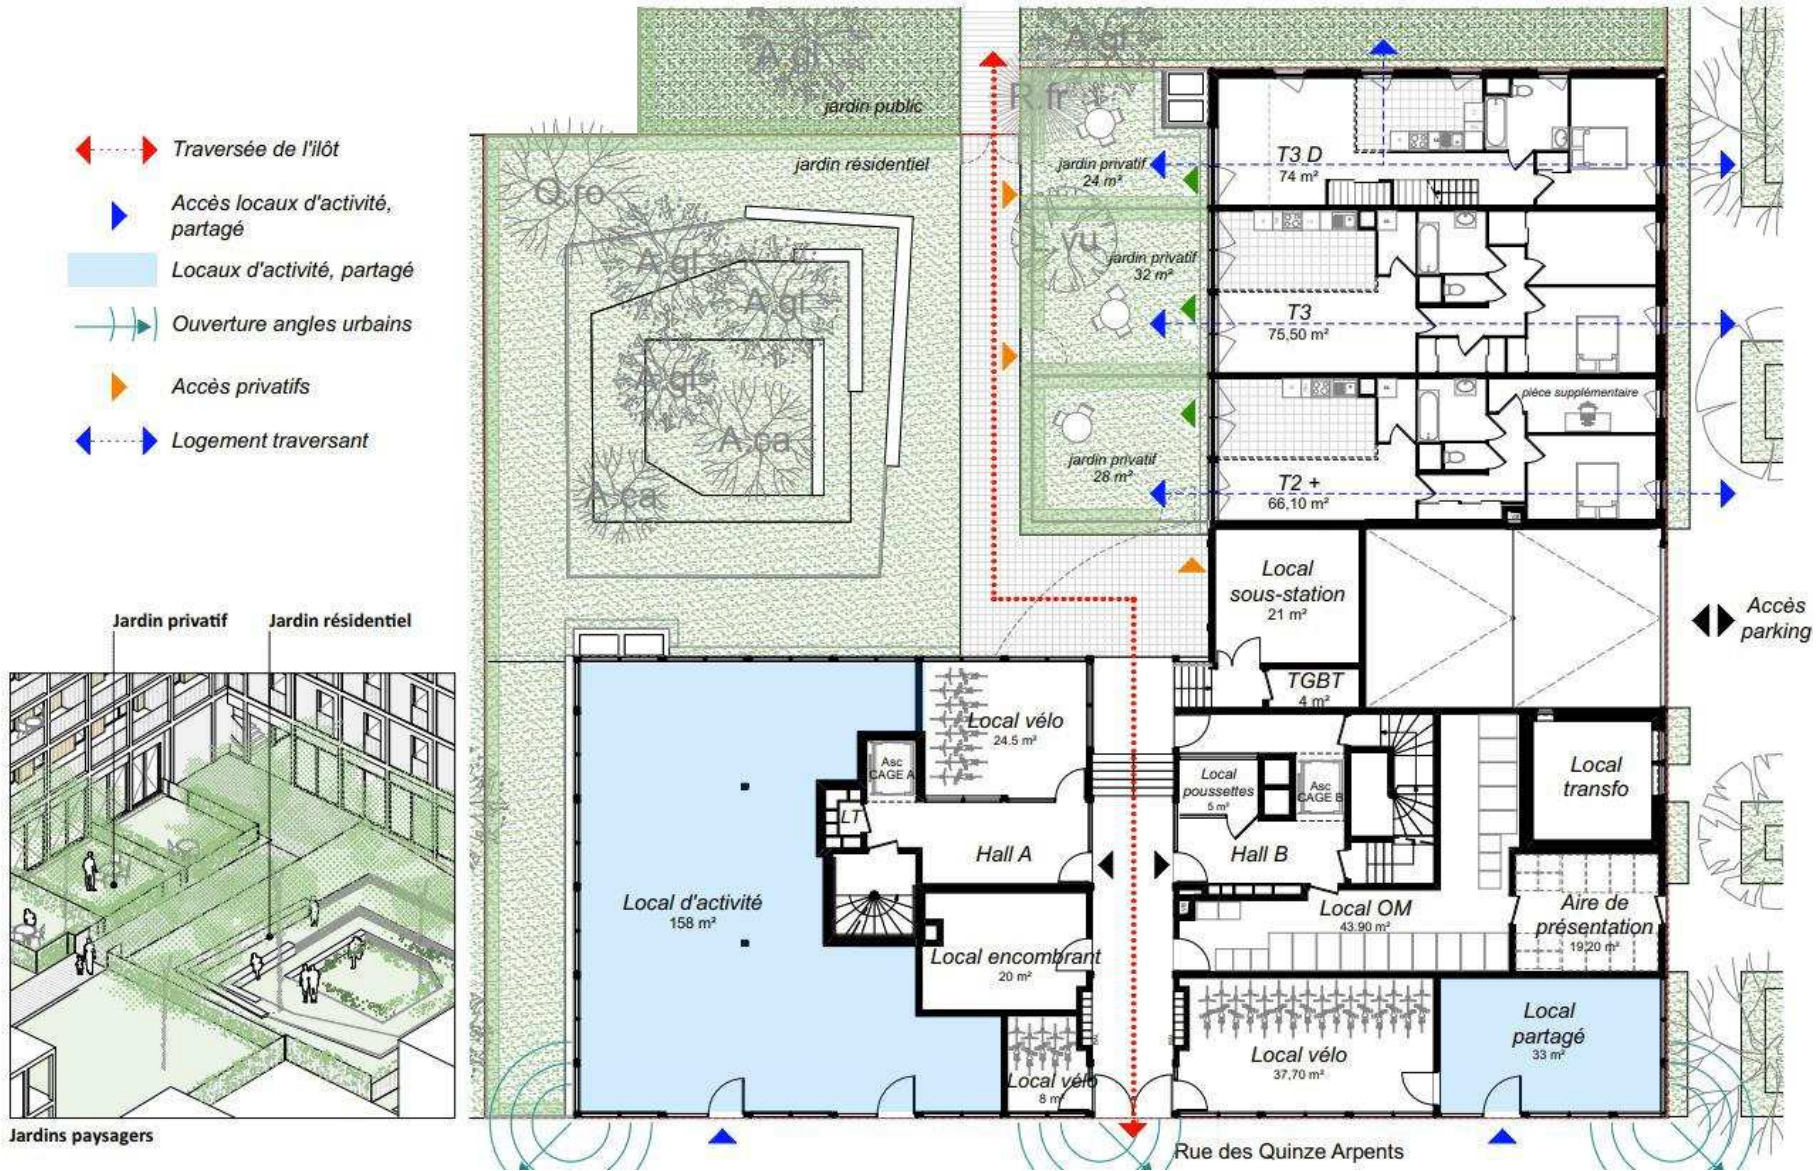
Plan masse du RDC des bâtiments du lot 4.3
